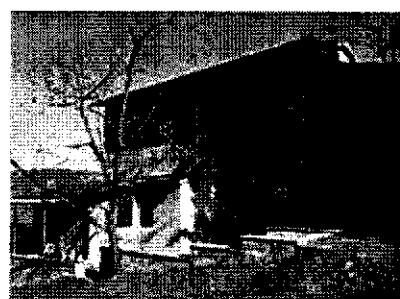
(edificio 10649) FOTO n° 50053 (edificio 10649) FOTO n° 50054 (edificio 10649)
